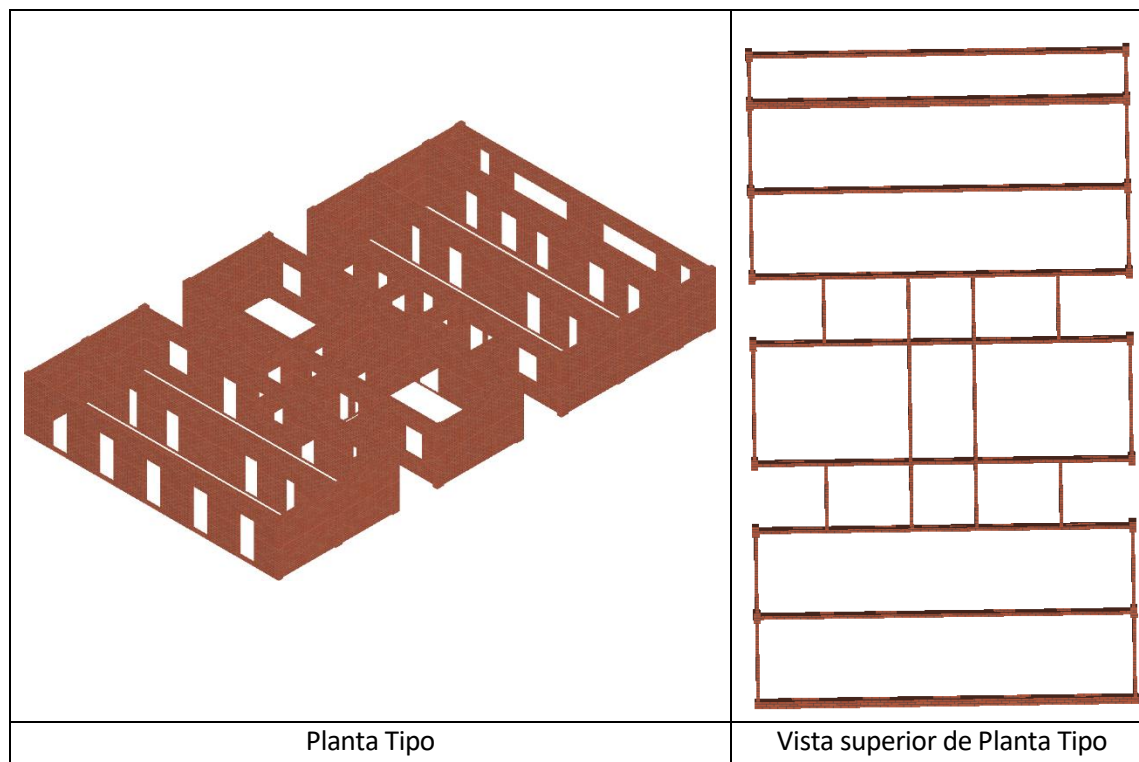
Modelo de Planta Tipo (Fuente: Propia)
